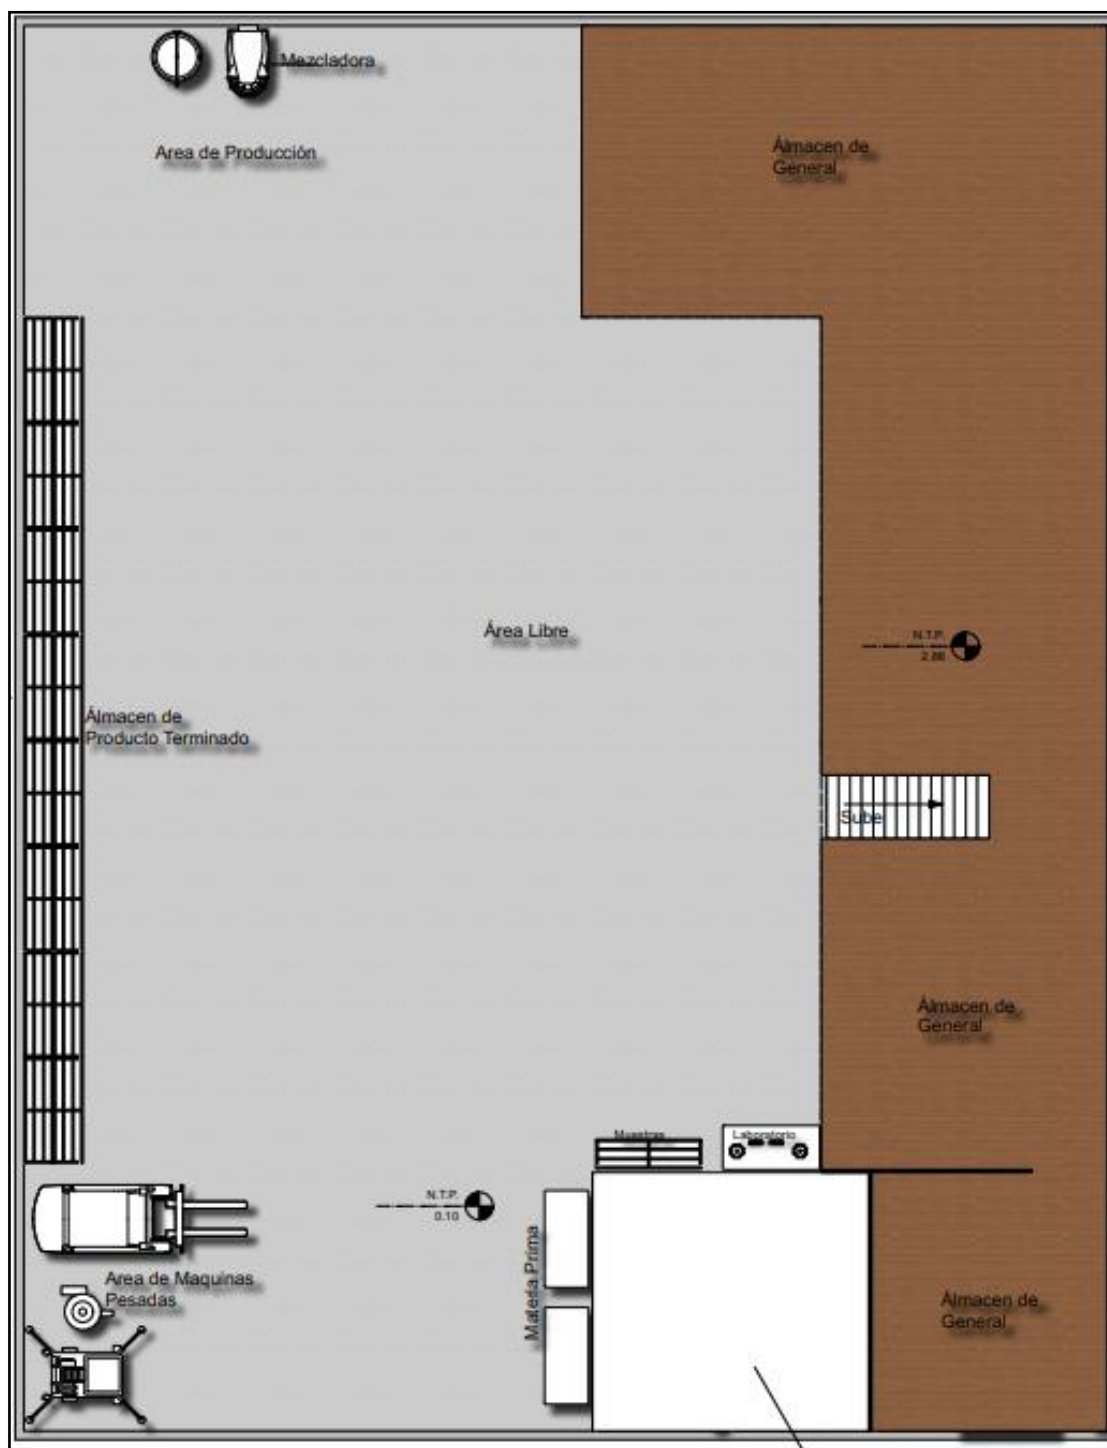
Planta Arquitectónica de la Instalación Few Group. Segundo Nivel.
